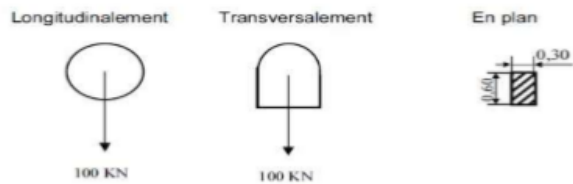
disposition du système Br pour calcul poinçonnement de la dalle
